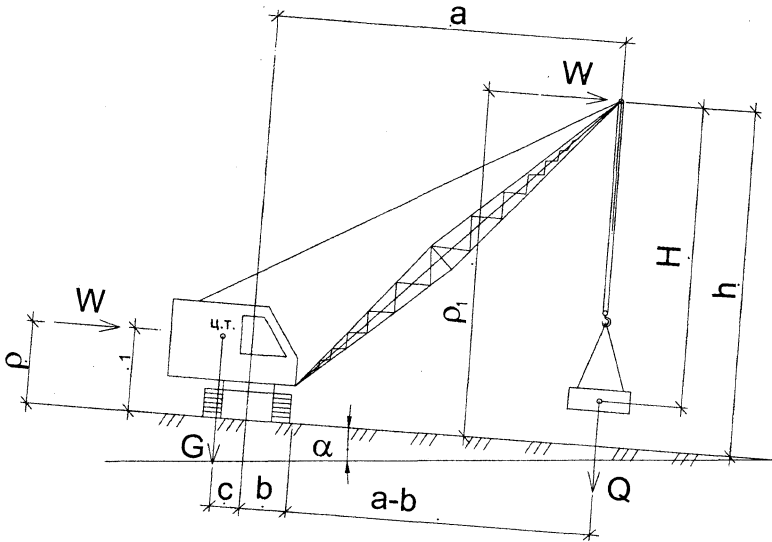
Расчётная схема грузовой устойчивости самоходного крана
